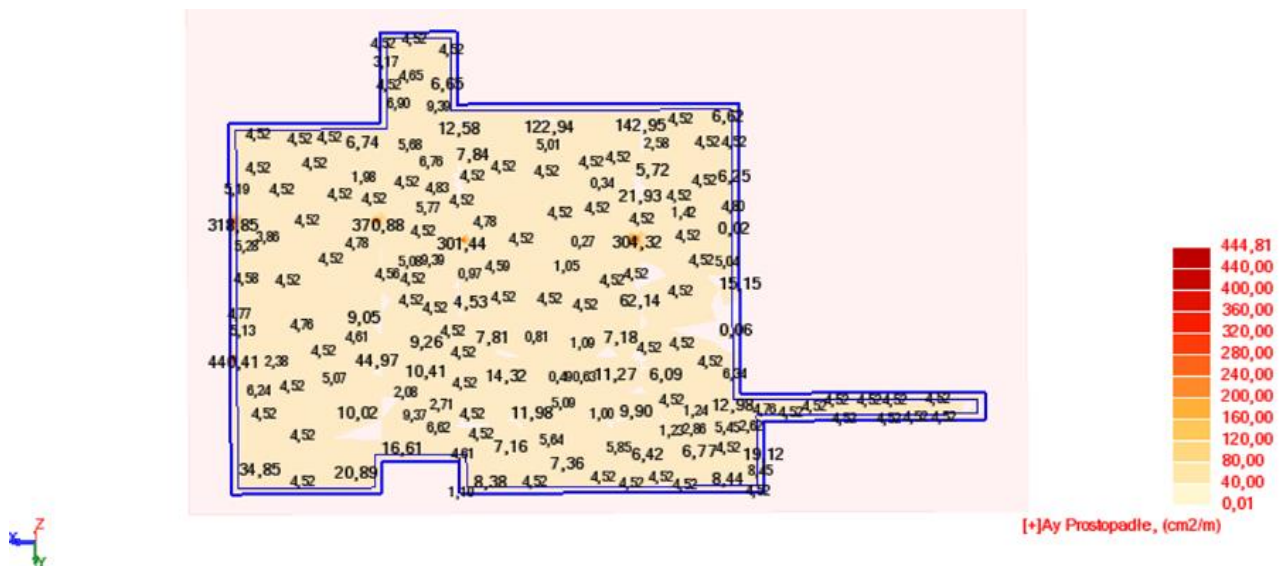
Wymagane zbrojenie dołem płyty fundamentowej w kierunku X.
